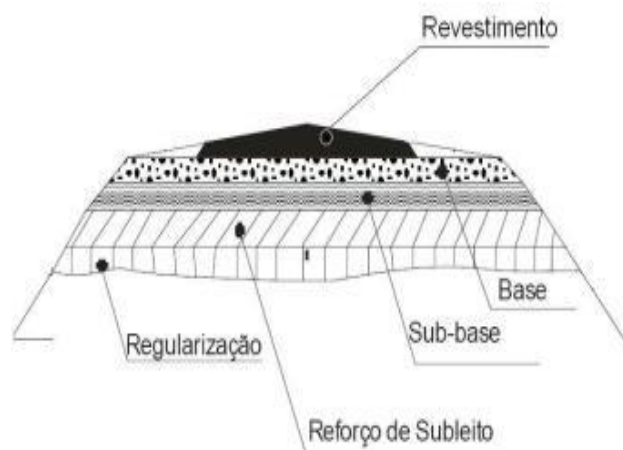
Seção transversal de um pavimento, DNIT (2006)
